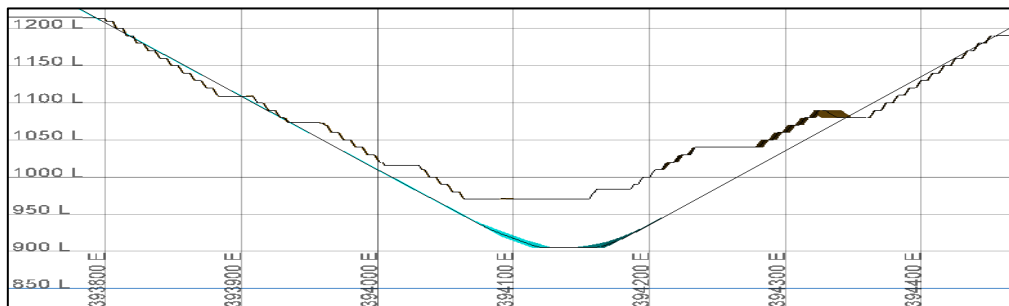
LGMM1Y Fase 5 - Vista en sección - Corte secundario E-O N
